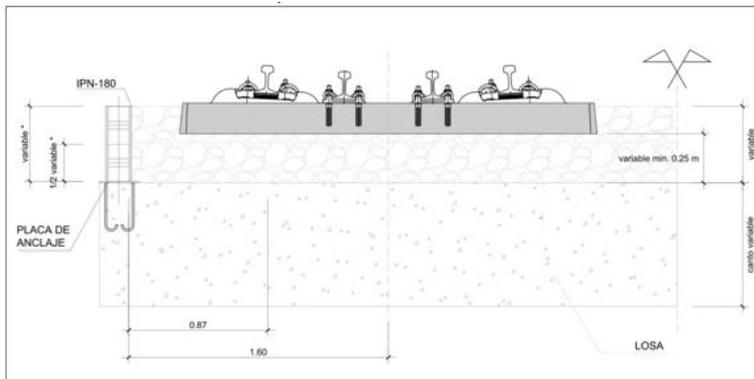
Detalle del murete guardabalasto que confina el balasto situado sobre la losa de transición, (FUENTE: Instrucción general para la redacción de proyectos de vía IGV-2011 [10]. IGV-1.15 Interacción vía-estructura)
